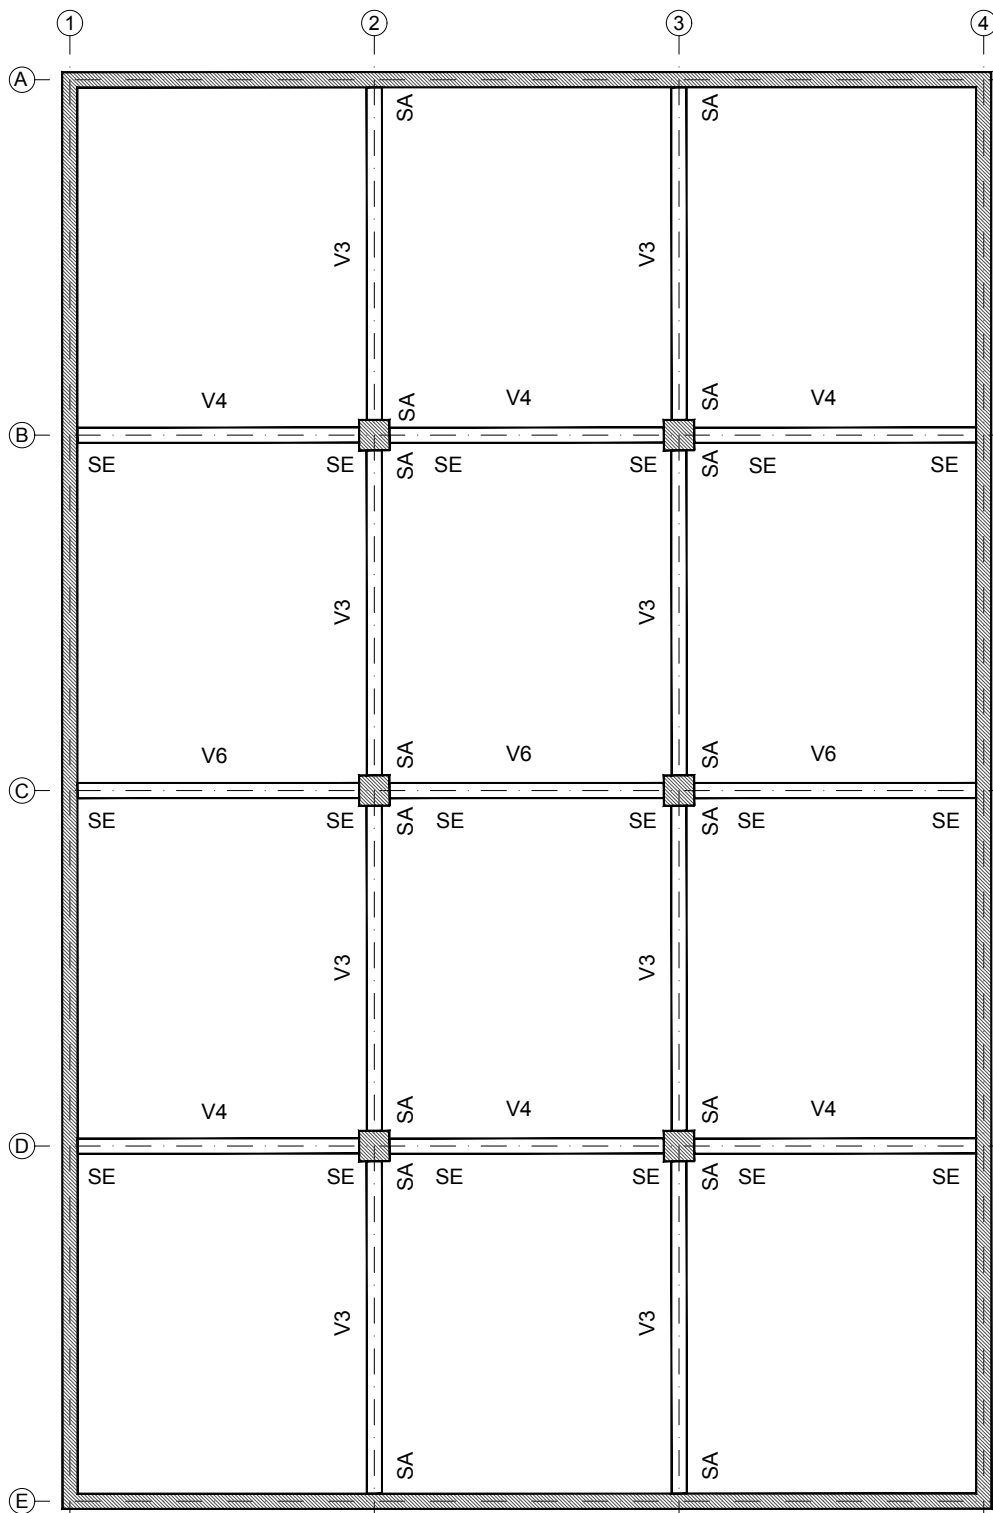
Vigas e secções de armadura das vigas – Piso 0.
